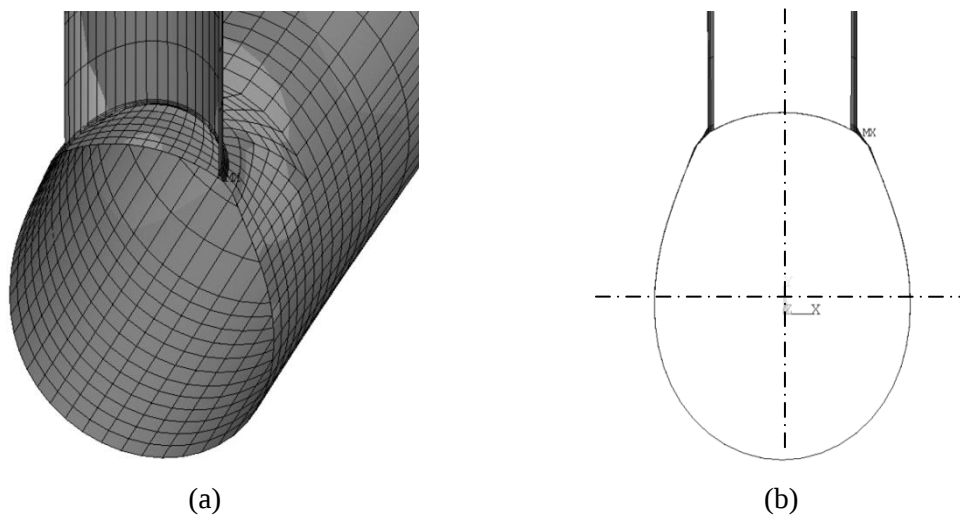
Falha por tração da ligação CHS-T-1 a 600 °C: (a) Corte, (b) Seção transversal
